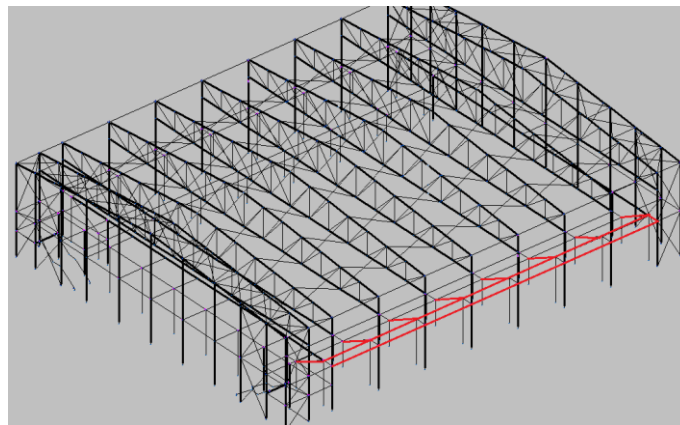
Vigas del graderío de la segunda planta (y sus simétricas).
